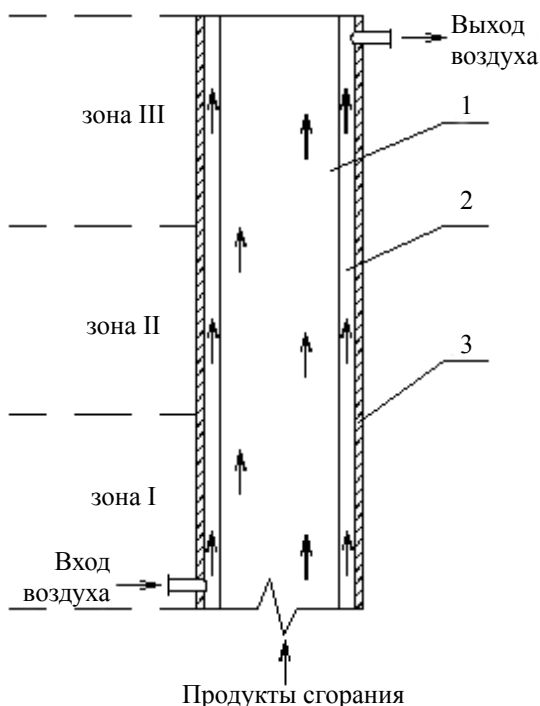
Металлическая дымовая труба: 1 – дымовая труба; 2 – кожух в виде кольцевого зазора; 3 – теплоизоляция
